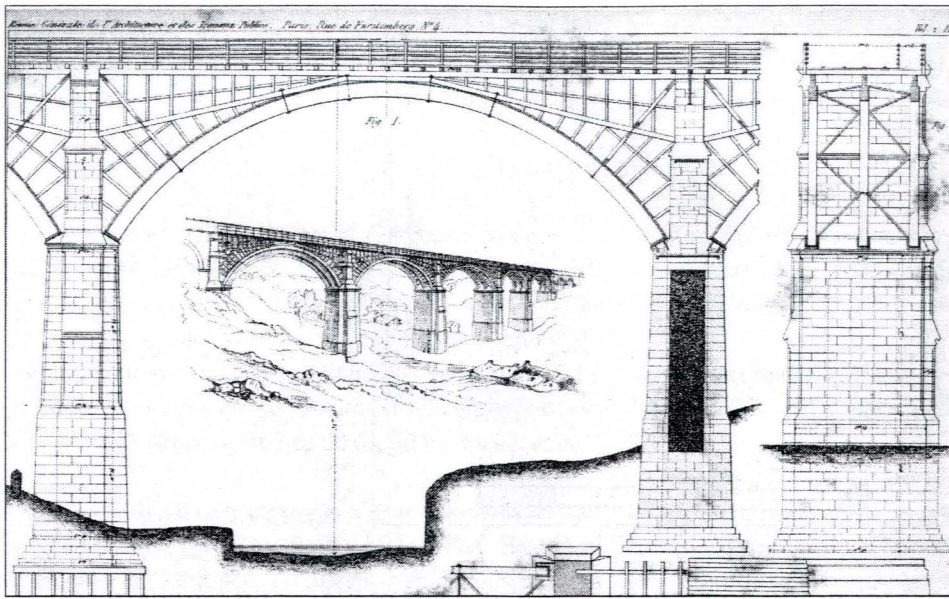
Puente mixto de madera y piedra sobre el Ousebourn
